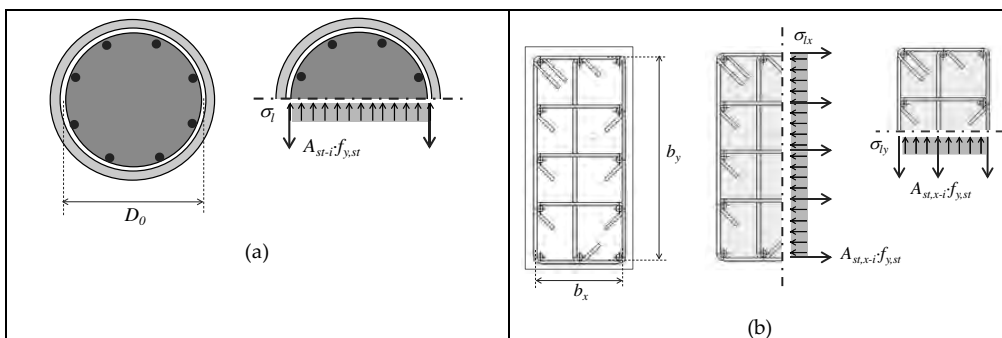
Pressione laterale di confinamento: (a) sezioni circolari, (b) sezioni rettangolari
